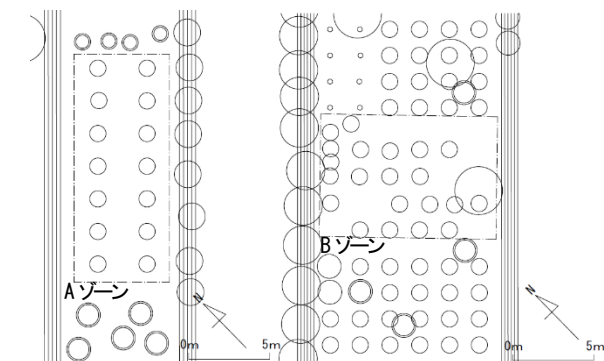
Aゾーン平面図 図-3 Bゾーン平面図
